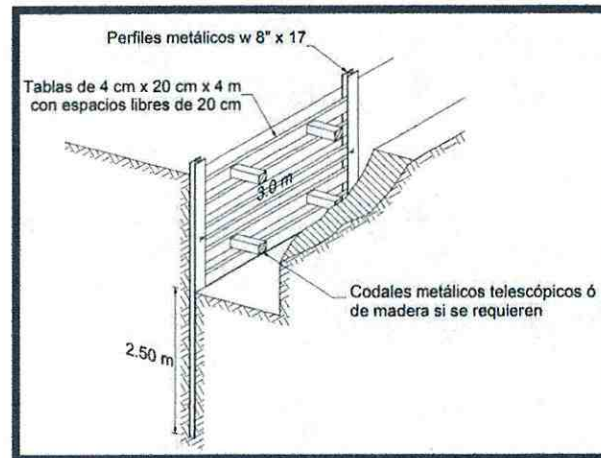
Esquema típico de entibado tipo 1ª alternativo
